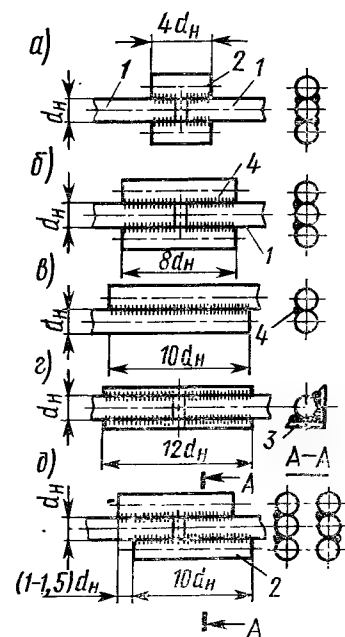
Типы стыков, выполняемых дуговой шовной сваркой:
